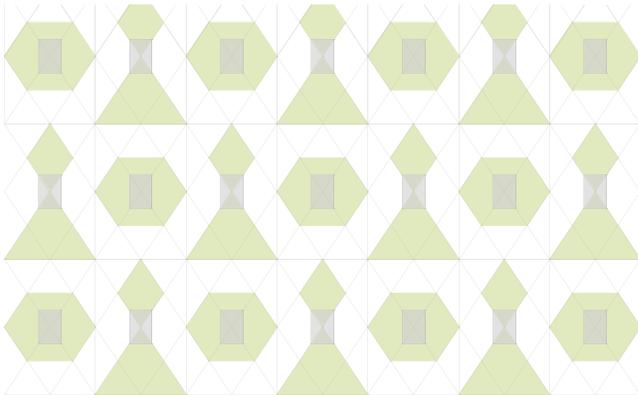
Trama 2 de locales y adaptación alrededor de cimentación existente.
